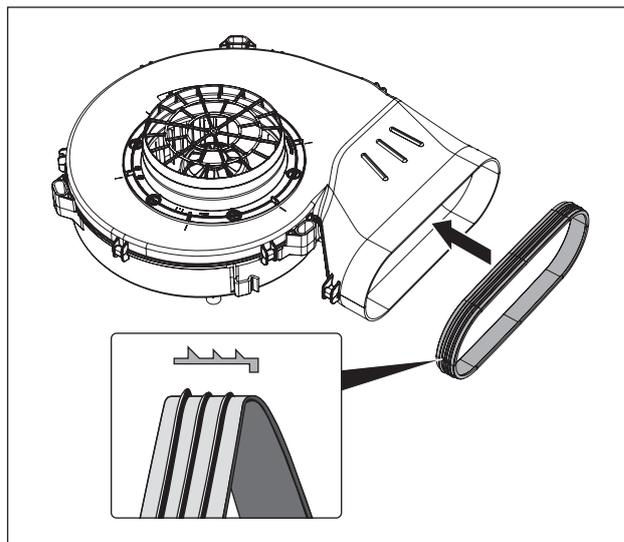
Aplicar a vedação na tubuladura de saída do ventilador de rodapé
